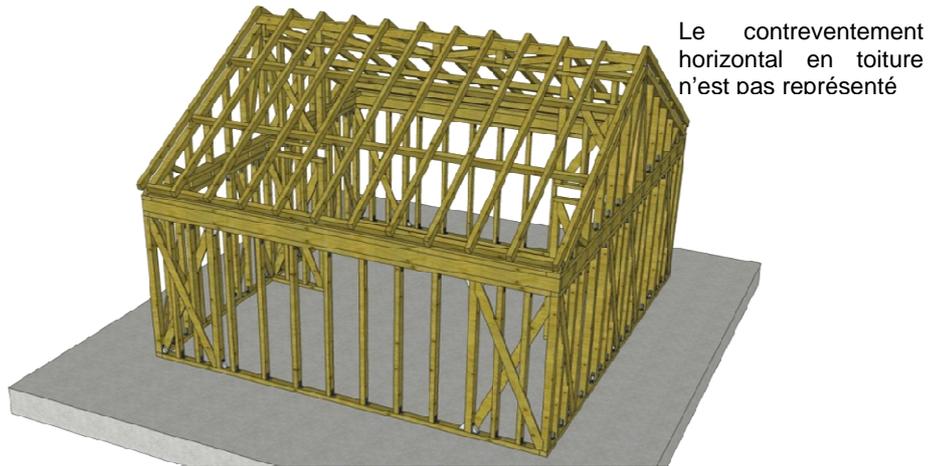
Exemple de maison à simple rez-de-chaussée avec toiture 2 versants
